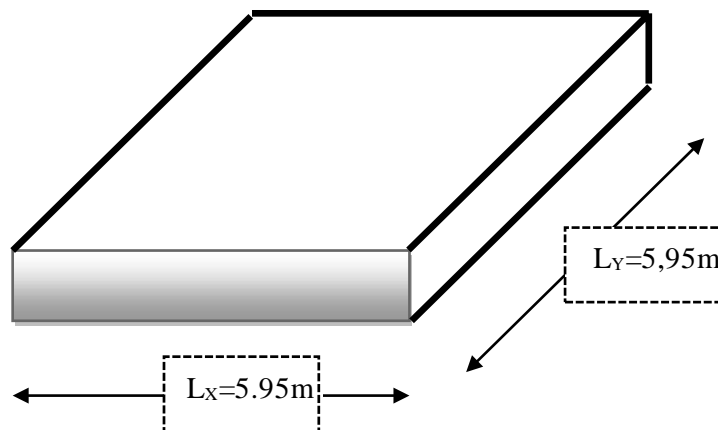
Vue en plan des dimensions du panneau le plus sollicité.
